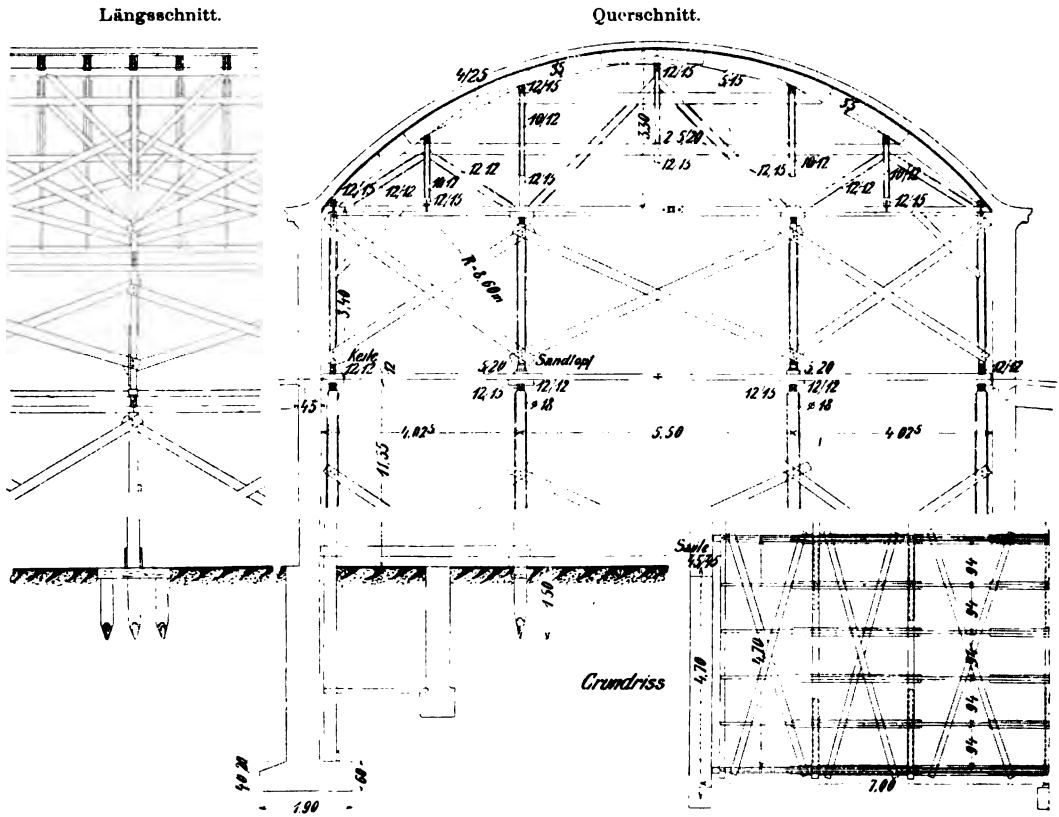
Lehrgerüst für die Maschinenhalle in Hanau.
